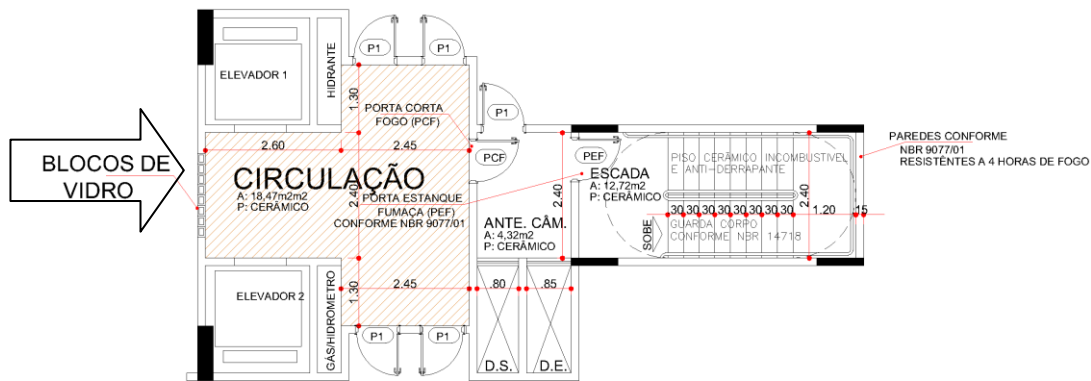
Demonstração Iluminação no Pavimento Tipo.
